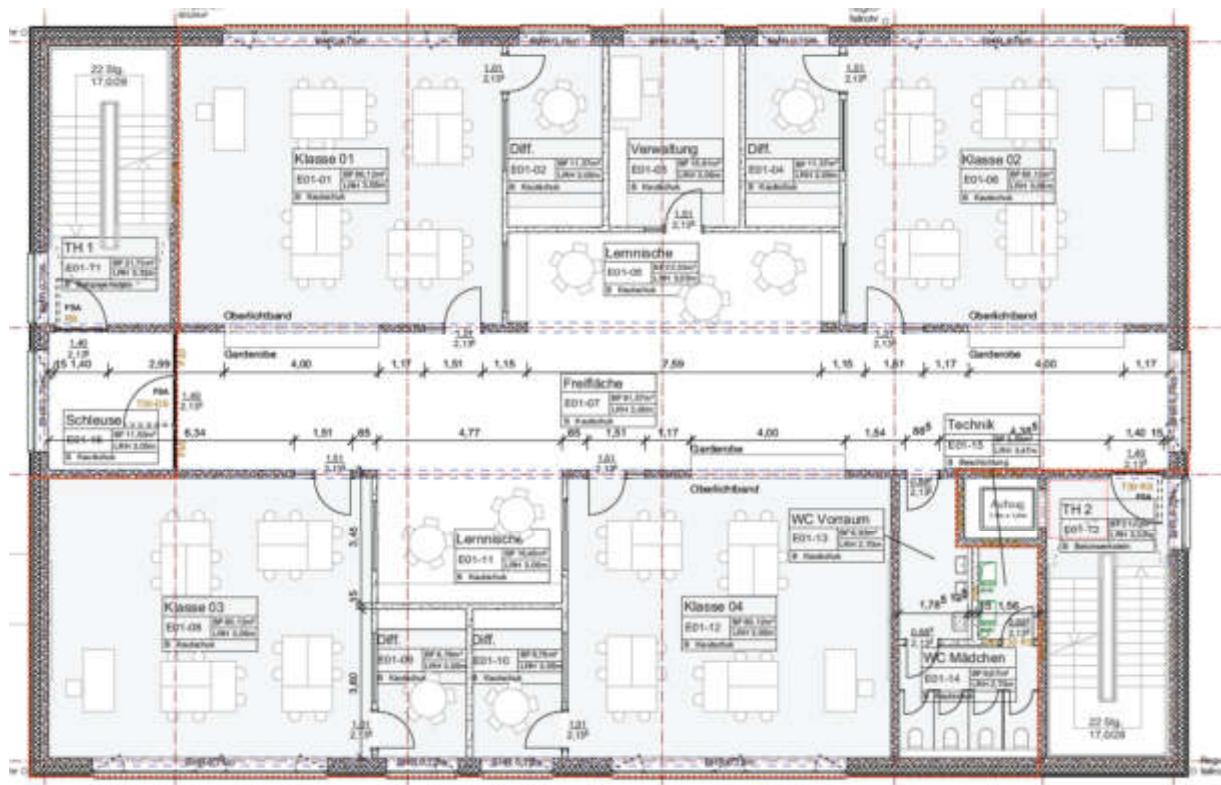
Grundrissdarstellung 1. OG
